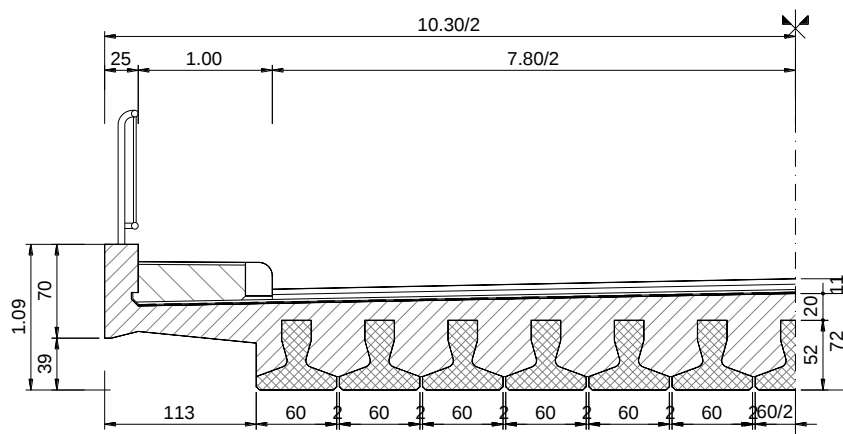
Secțiune transversală – Dală din elemente prefabricate solidarizate
